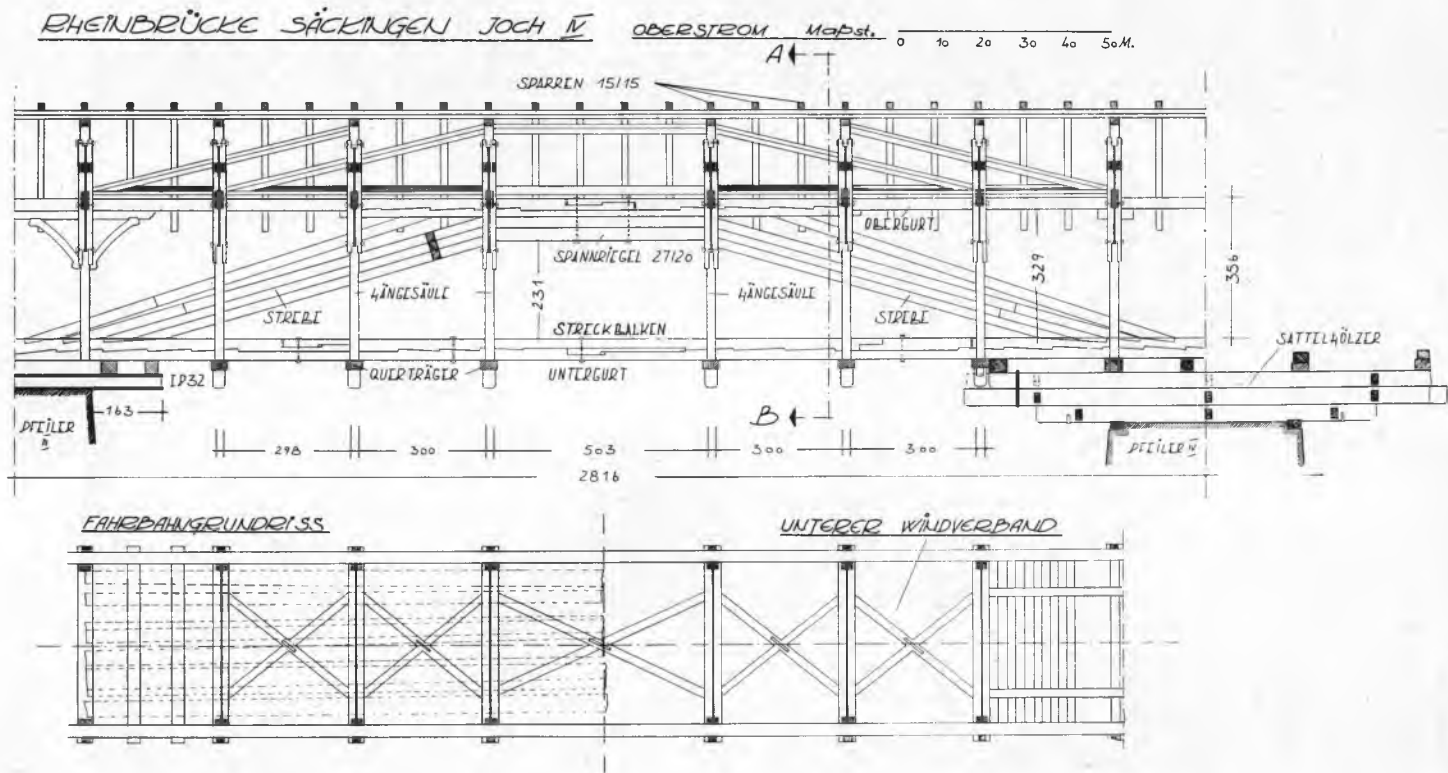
Längsschnitt und Grundriß zu dem Joch IV
